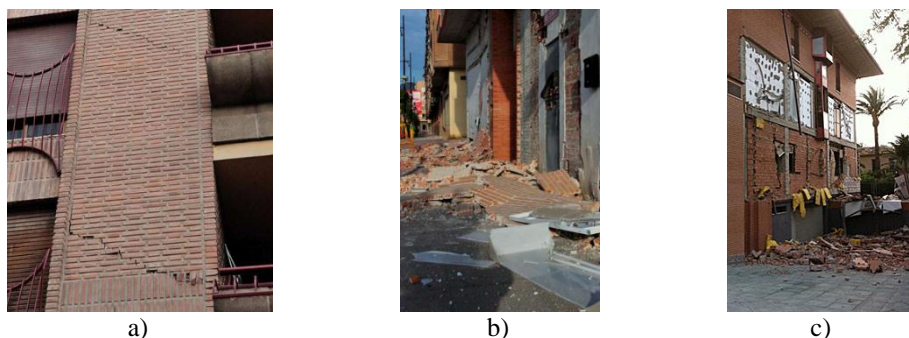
Danos em edifícios de betão armado com painéis de alvenaria de enchimento (Lorca, 2011): a) danos no plano das paredes de alvenaria; b) e c) Colapso de painéis de alvenaria para fora do seu plano [23]
